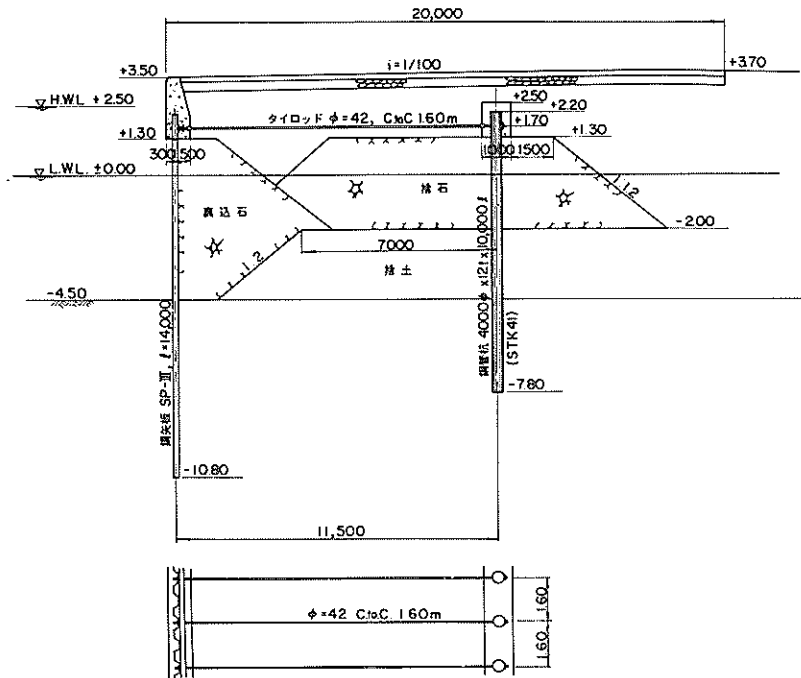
鋼矢板式 - 4.50 m岸壁標準断面図
